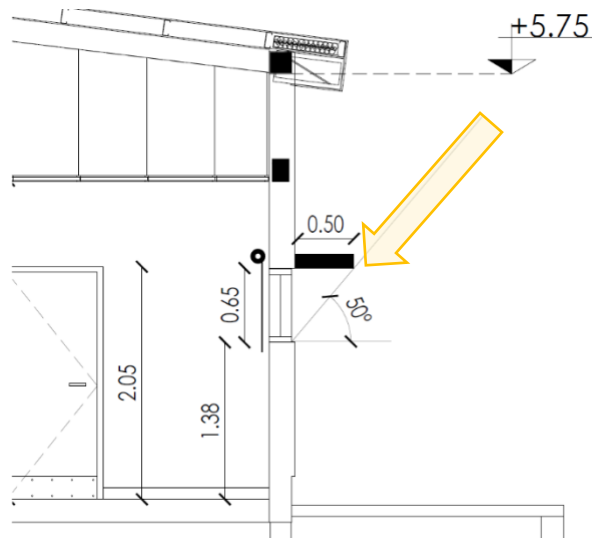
Corte de situación de protección aplicación de control solar tipo cortina
